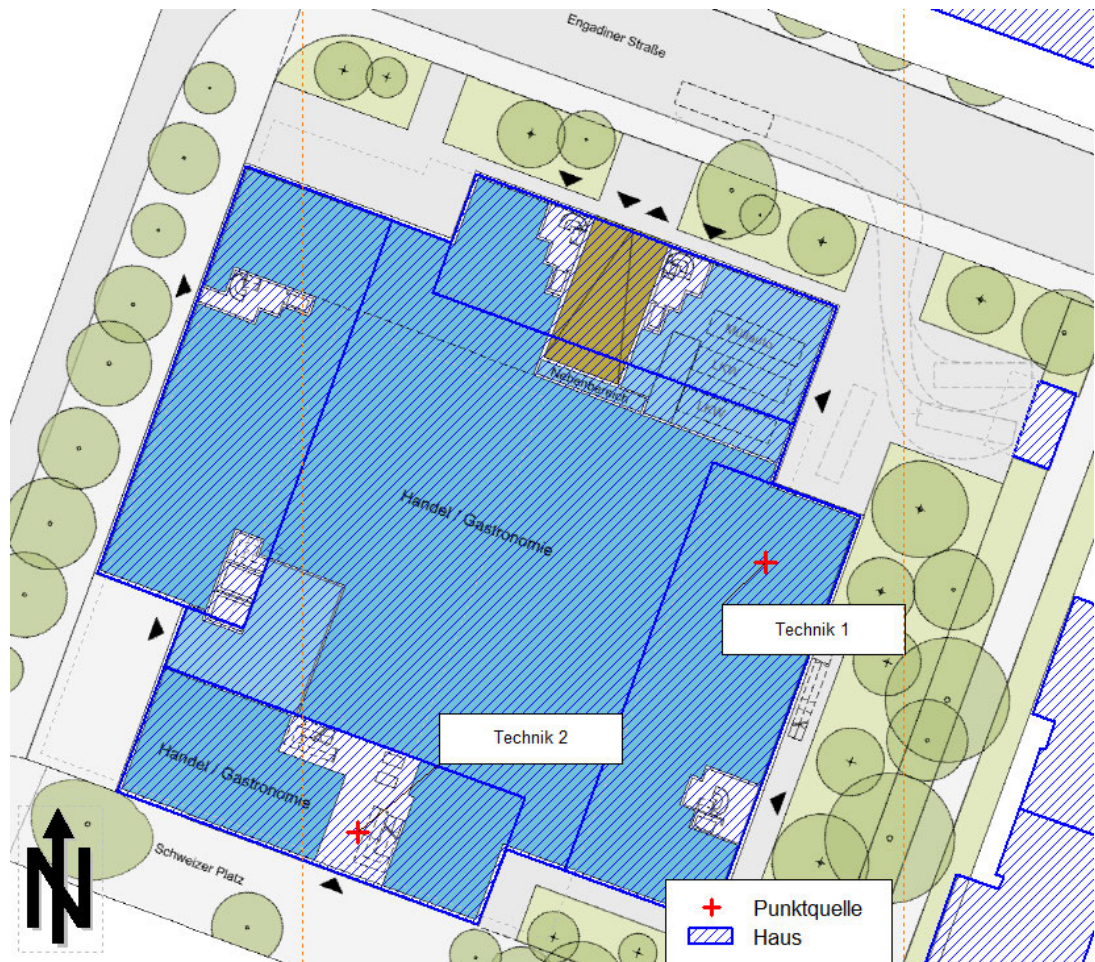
Lageplan [1], mit Positionierung Rückkühlwerke (ohne Maßstab).
